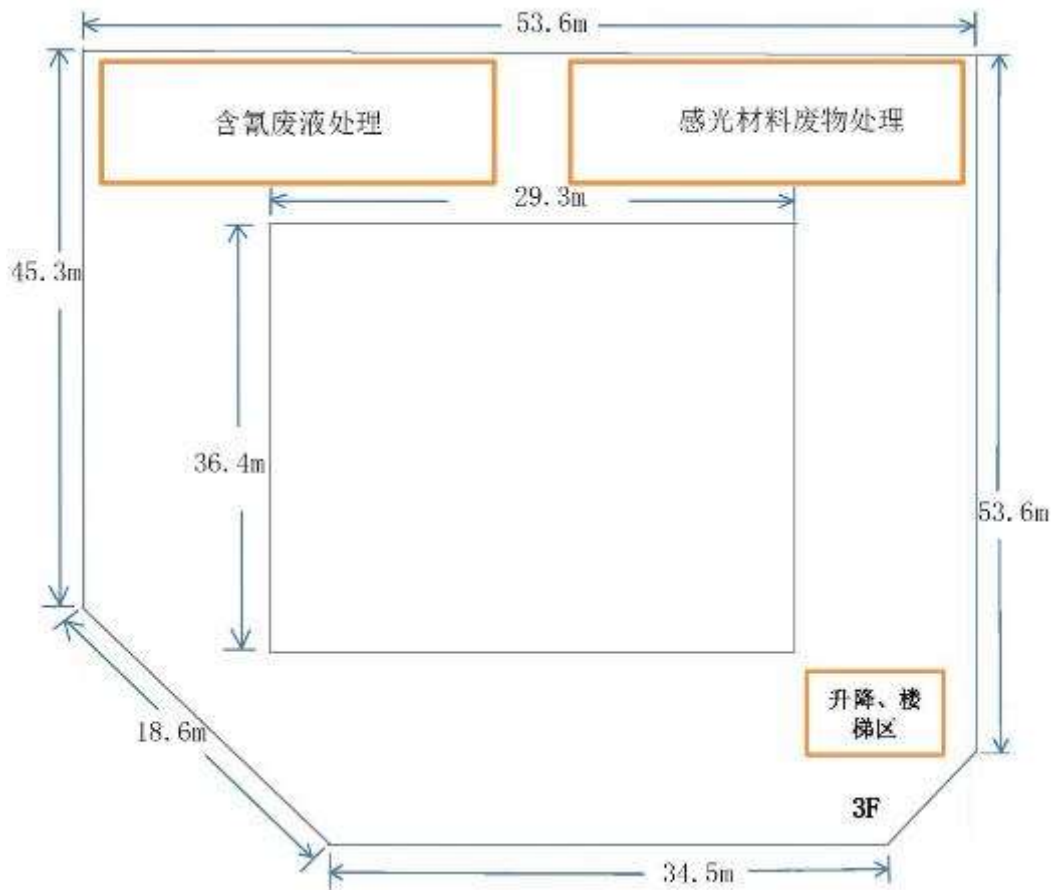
搬迁及改扩建后北厂区 2# 厂房三层平面布置图
